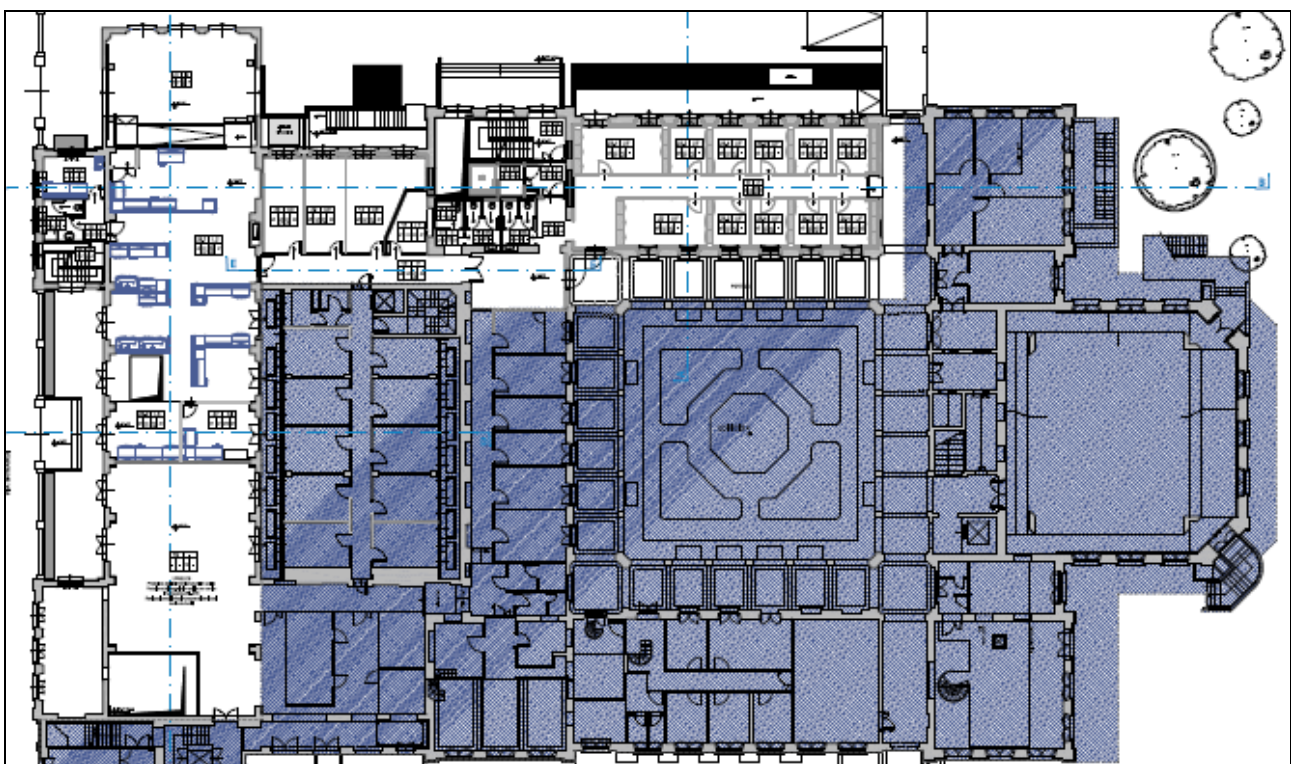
Individuazione Lotto 1 (spazi in bianco non evidenziati da campiture)
